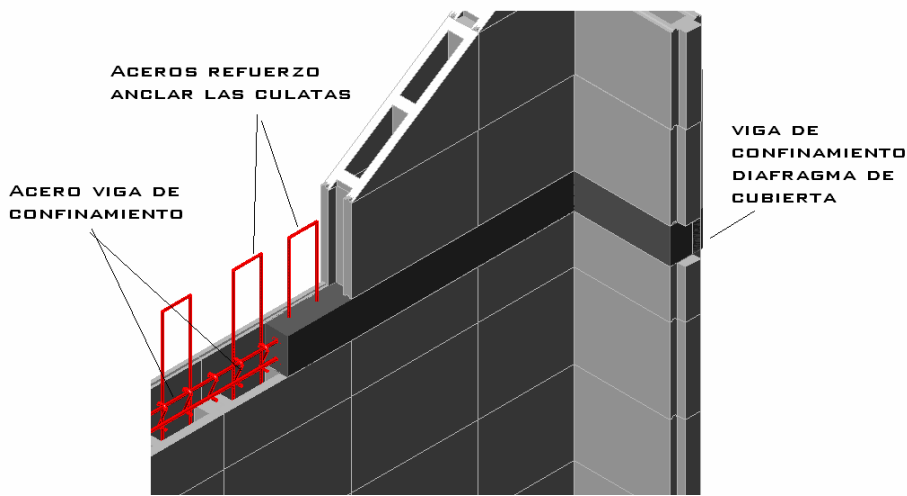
DETALLE VIGA CONFINAMIENTO., DE CUBIERTA ACEROS DE TRANSFERENCIA ANCLADOS EN LA VIGA, ZONA A
